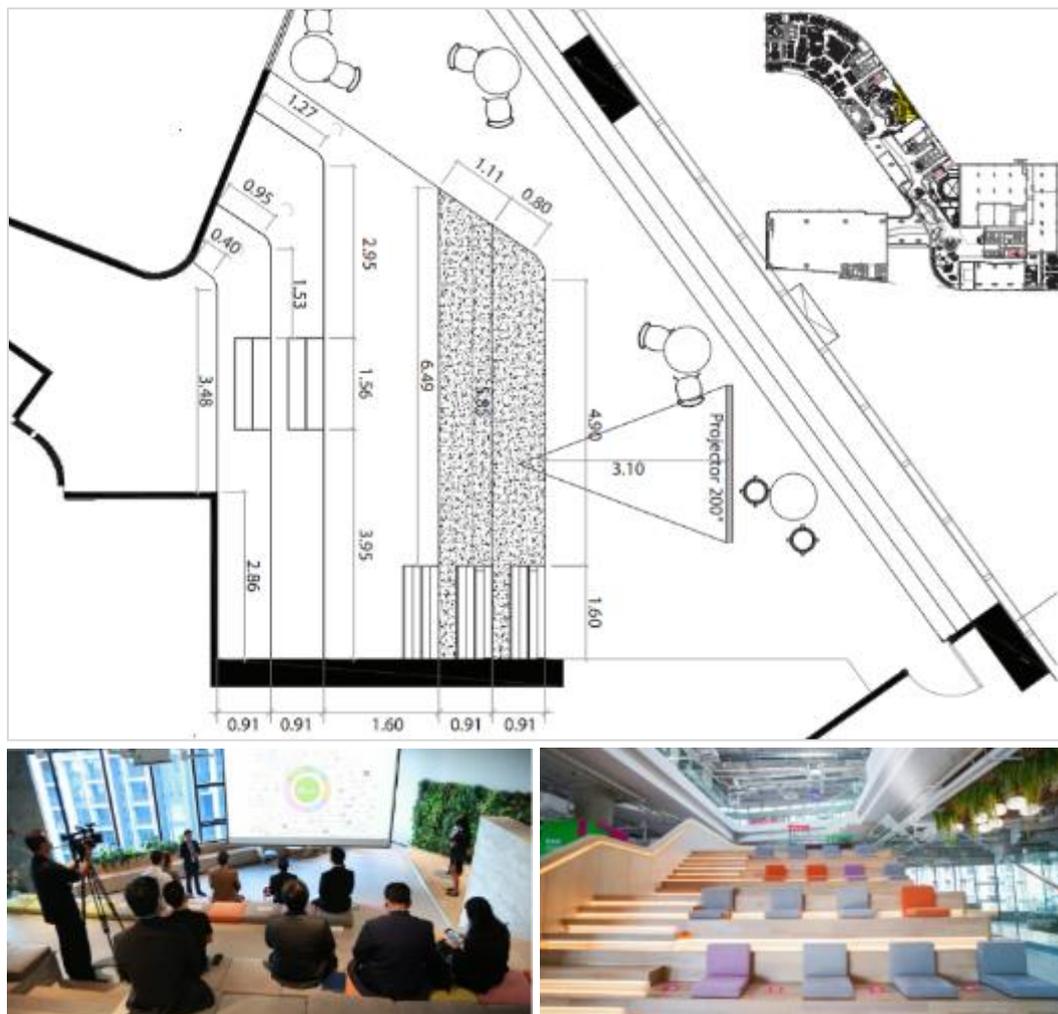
True Digital Park - Planta e Vista do Anfiteatro S Piso 6
